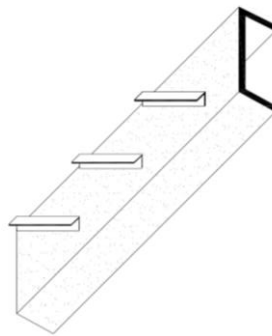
Perfiles PNL sobre viga inclinada de tramo
